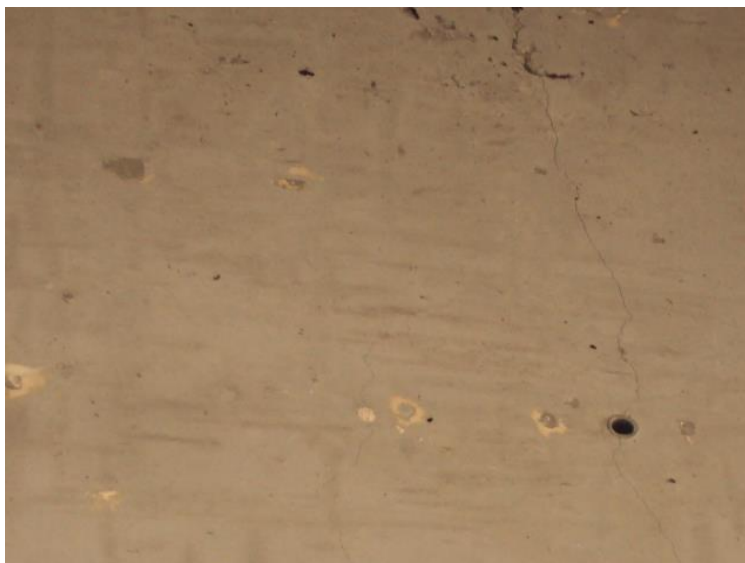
Presencia de micro fisuras de 0.2 mm a 0.3 mm de espesor, en viga central (fuente propia)
